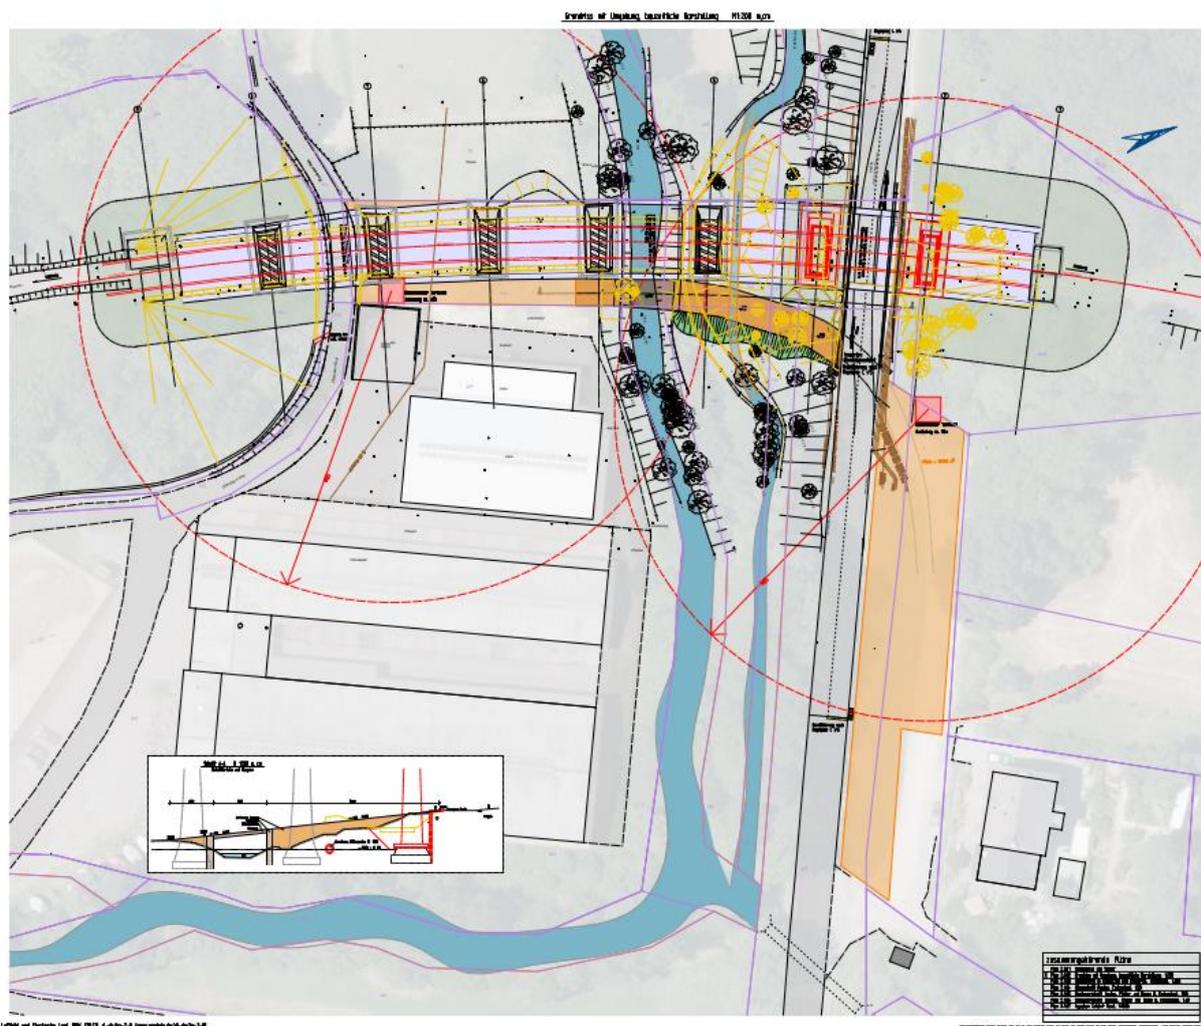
Grundriss bauzeitliche Darstellung
